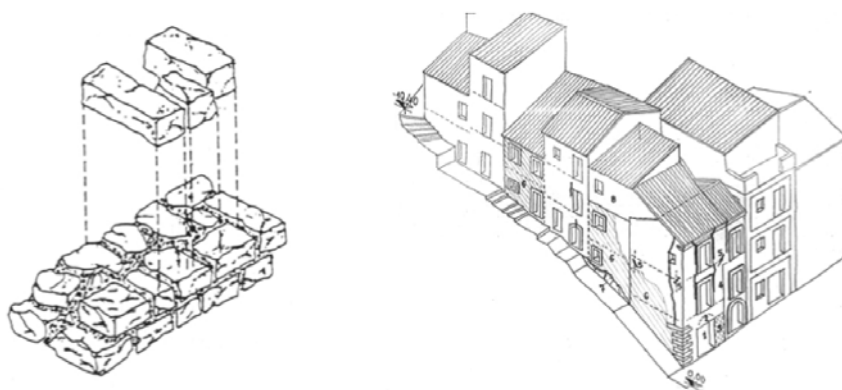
La parete muraria come assemblaggio di elementi lapidei (sx) e il tessuto come assemblaggio di case (dx).
